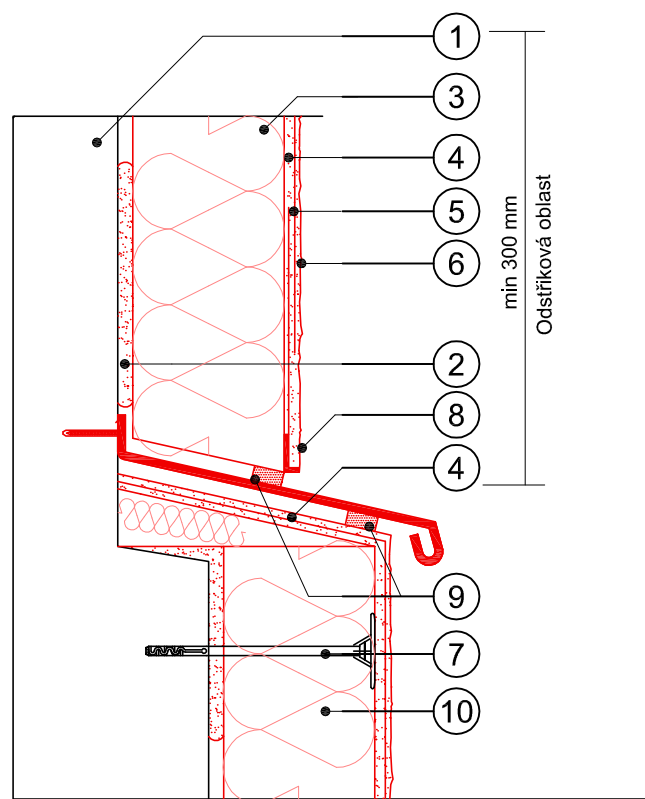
NAPOJENÍ NA EXISTUJÍCÍ POVRCH TERÉNU / M 1:5
